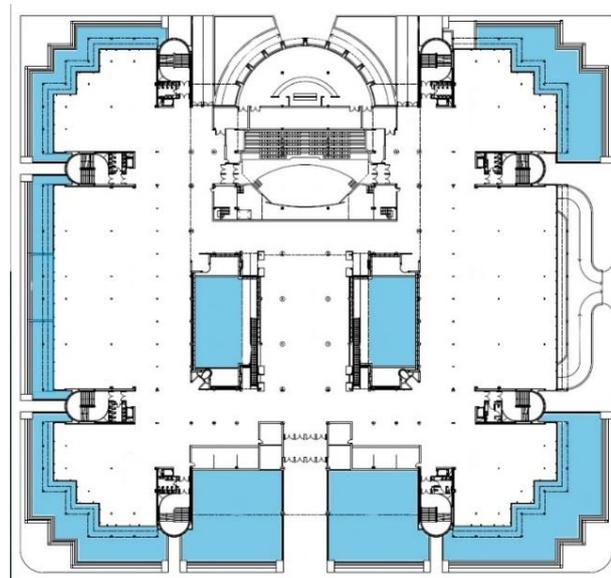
Plano de planta baja donde se han coloreado las láminas de agua
